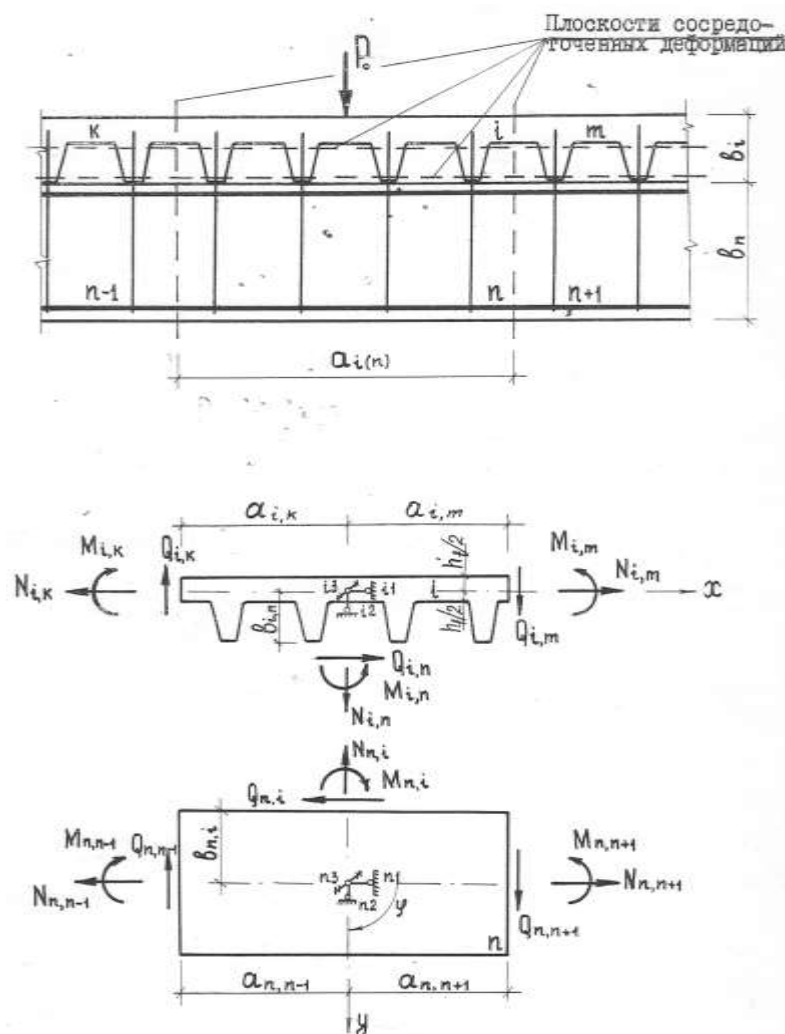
Расчетная схема комбинированной балки: а) — схема разбивки; б) — схема внутренних усилий
